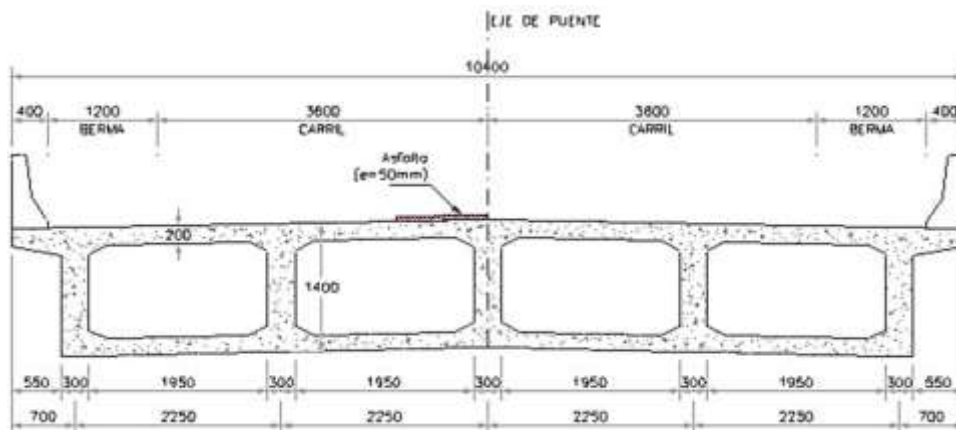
Sección Típica de vigas "Cajón" en las zonas de momento negativo de la Superestructura para los Puentes estudiados.
